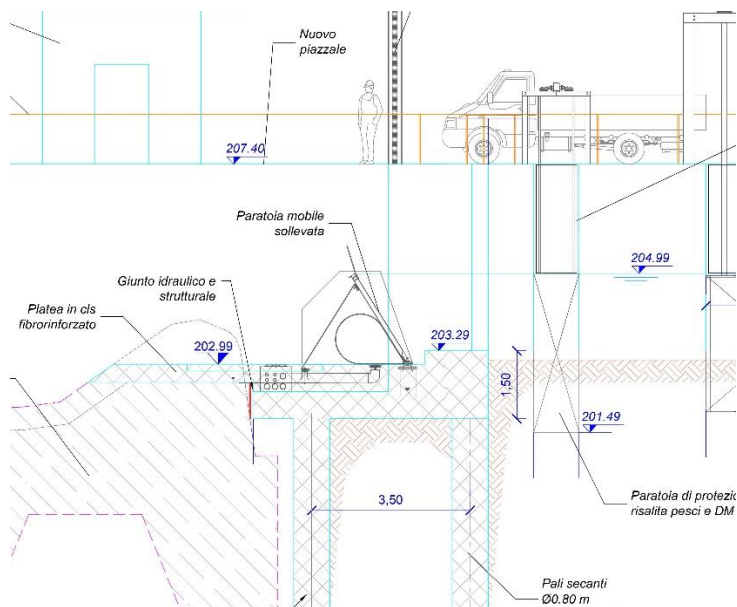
Particolare estratto dalle tavole di progetto dell'intervento di scapitozzatura della traversa esistente e di sopraelevazione con sbarramento gonfiabile
